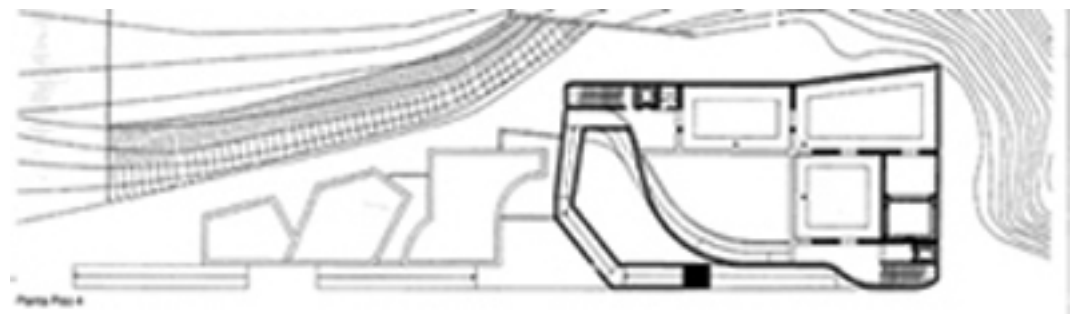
Planta baixa do 2º pavimento do Museu Iberê Camargo.
